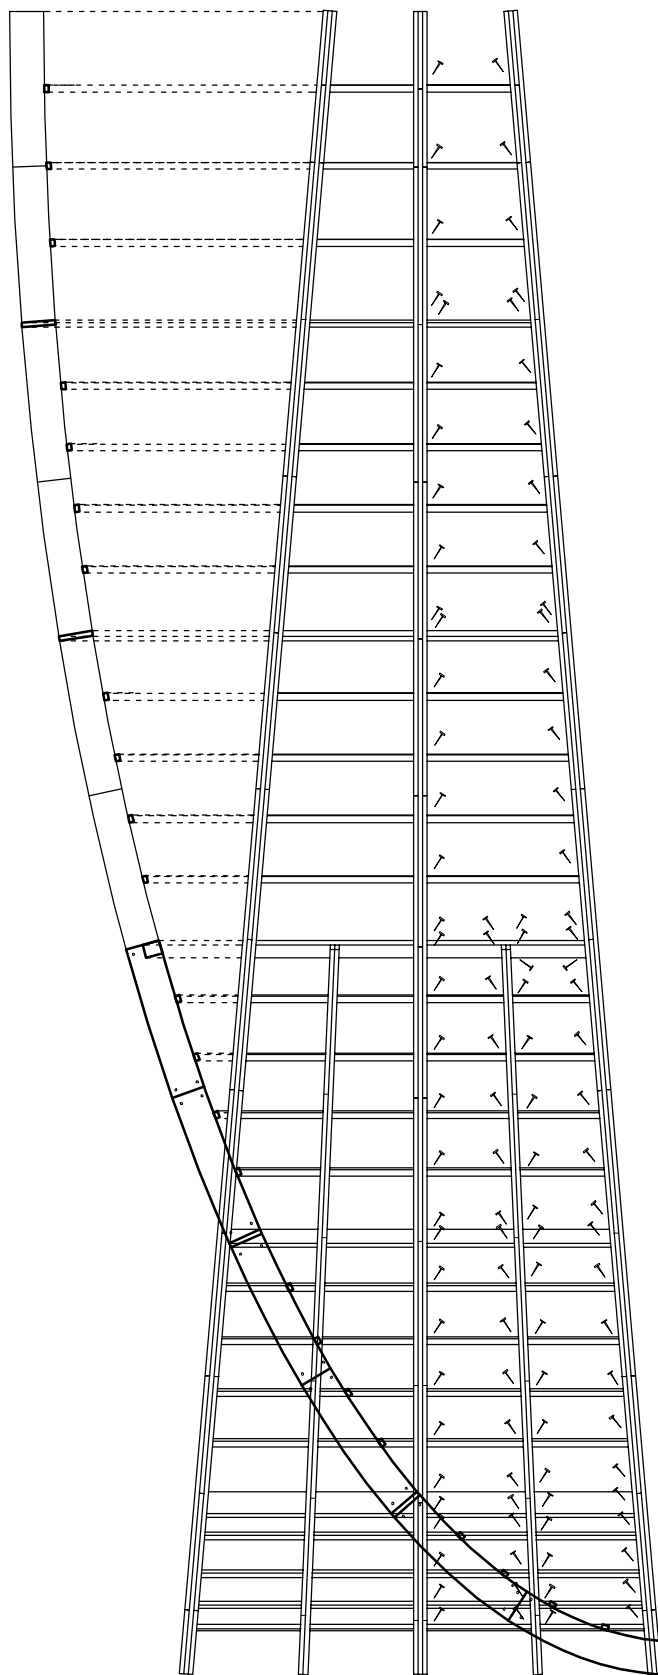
Teatro Storchi di Modena. Rappresentazione in pianta e sezione di una porzione della struttura lignea della volta.
